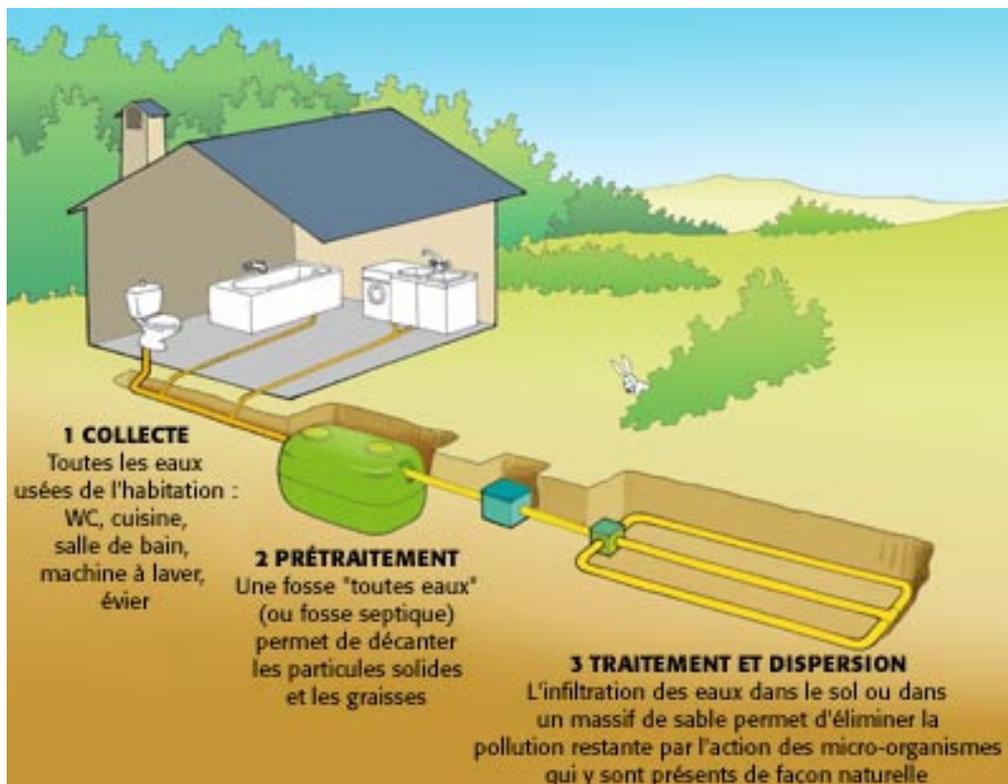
Schéma d'un dispositif d'assainissement non collectif (site Internet ADEME)
